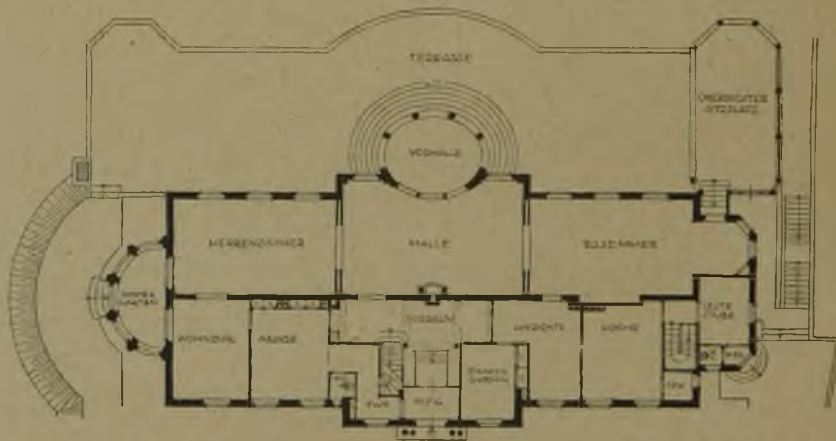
Grundriß des Erdgeschosses. 1 : 400.
